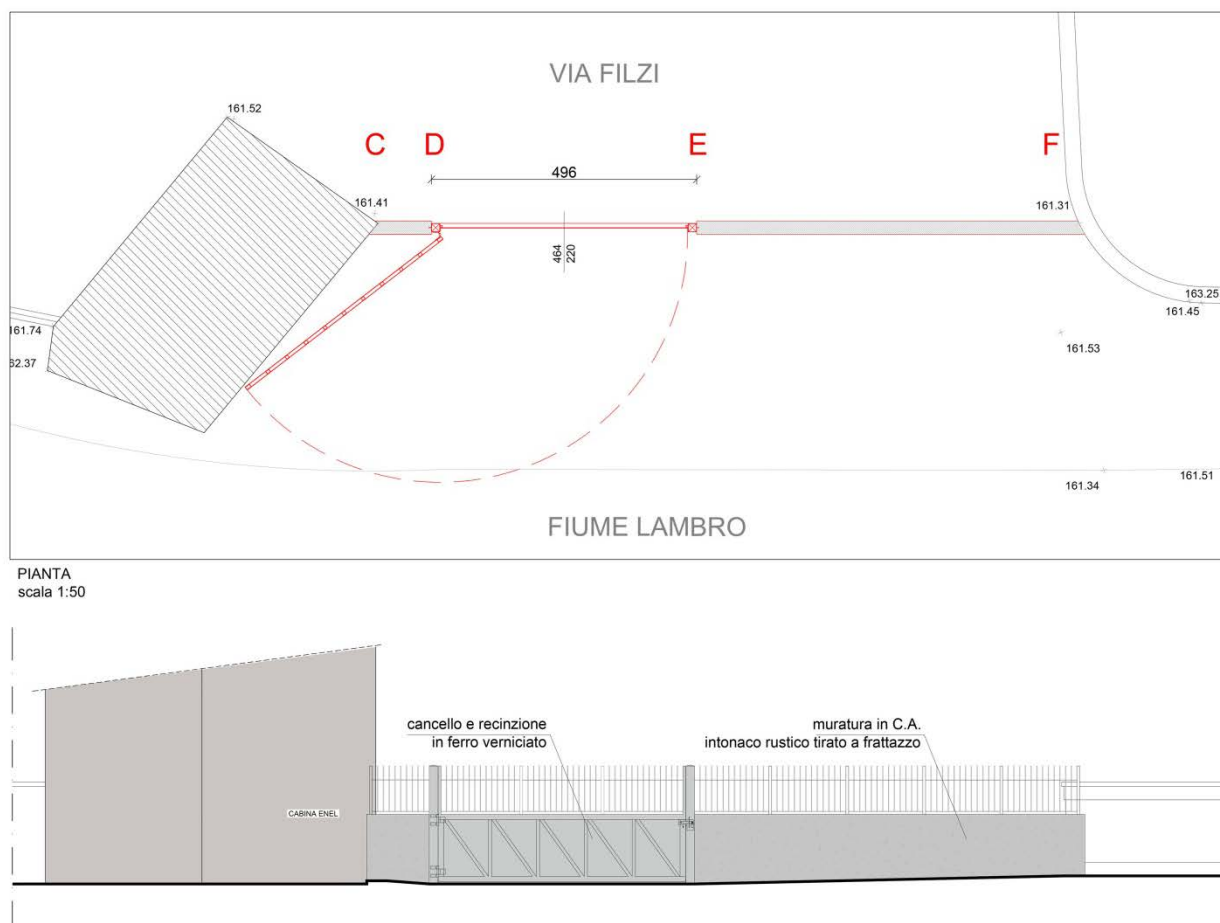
Pianta e prospetto della nuova recinzione verso il fiume Lambro
